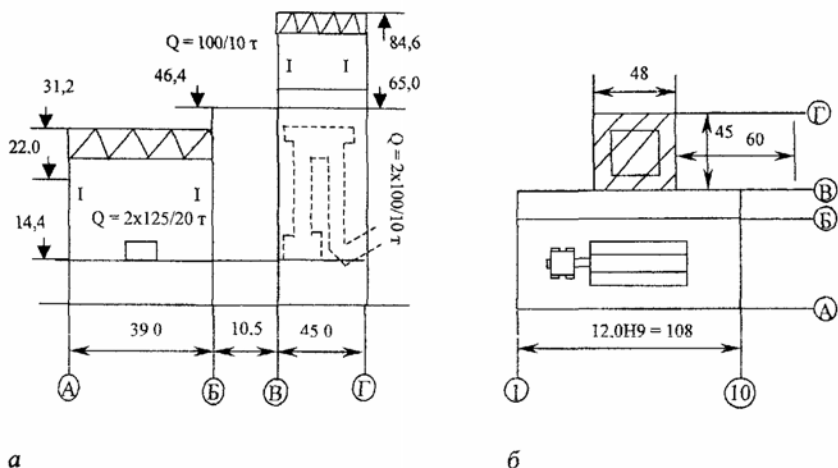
Главный корпус газомазутной КЭС с блоками 800 МВт:
